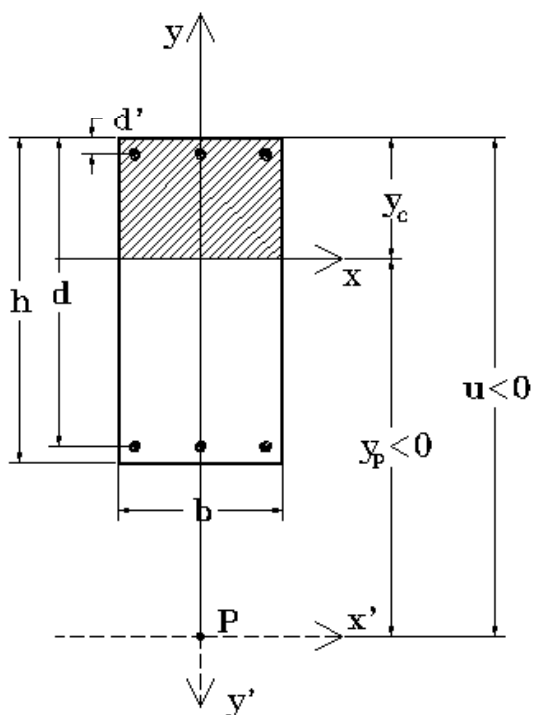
Sezione rettangolare sollecitata da tensoflessione retta
